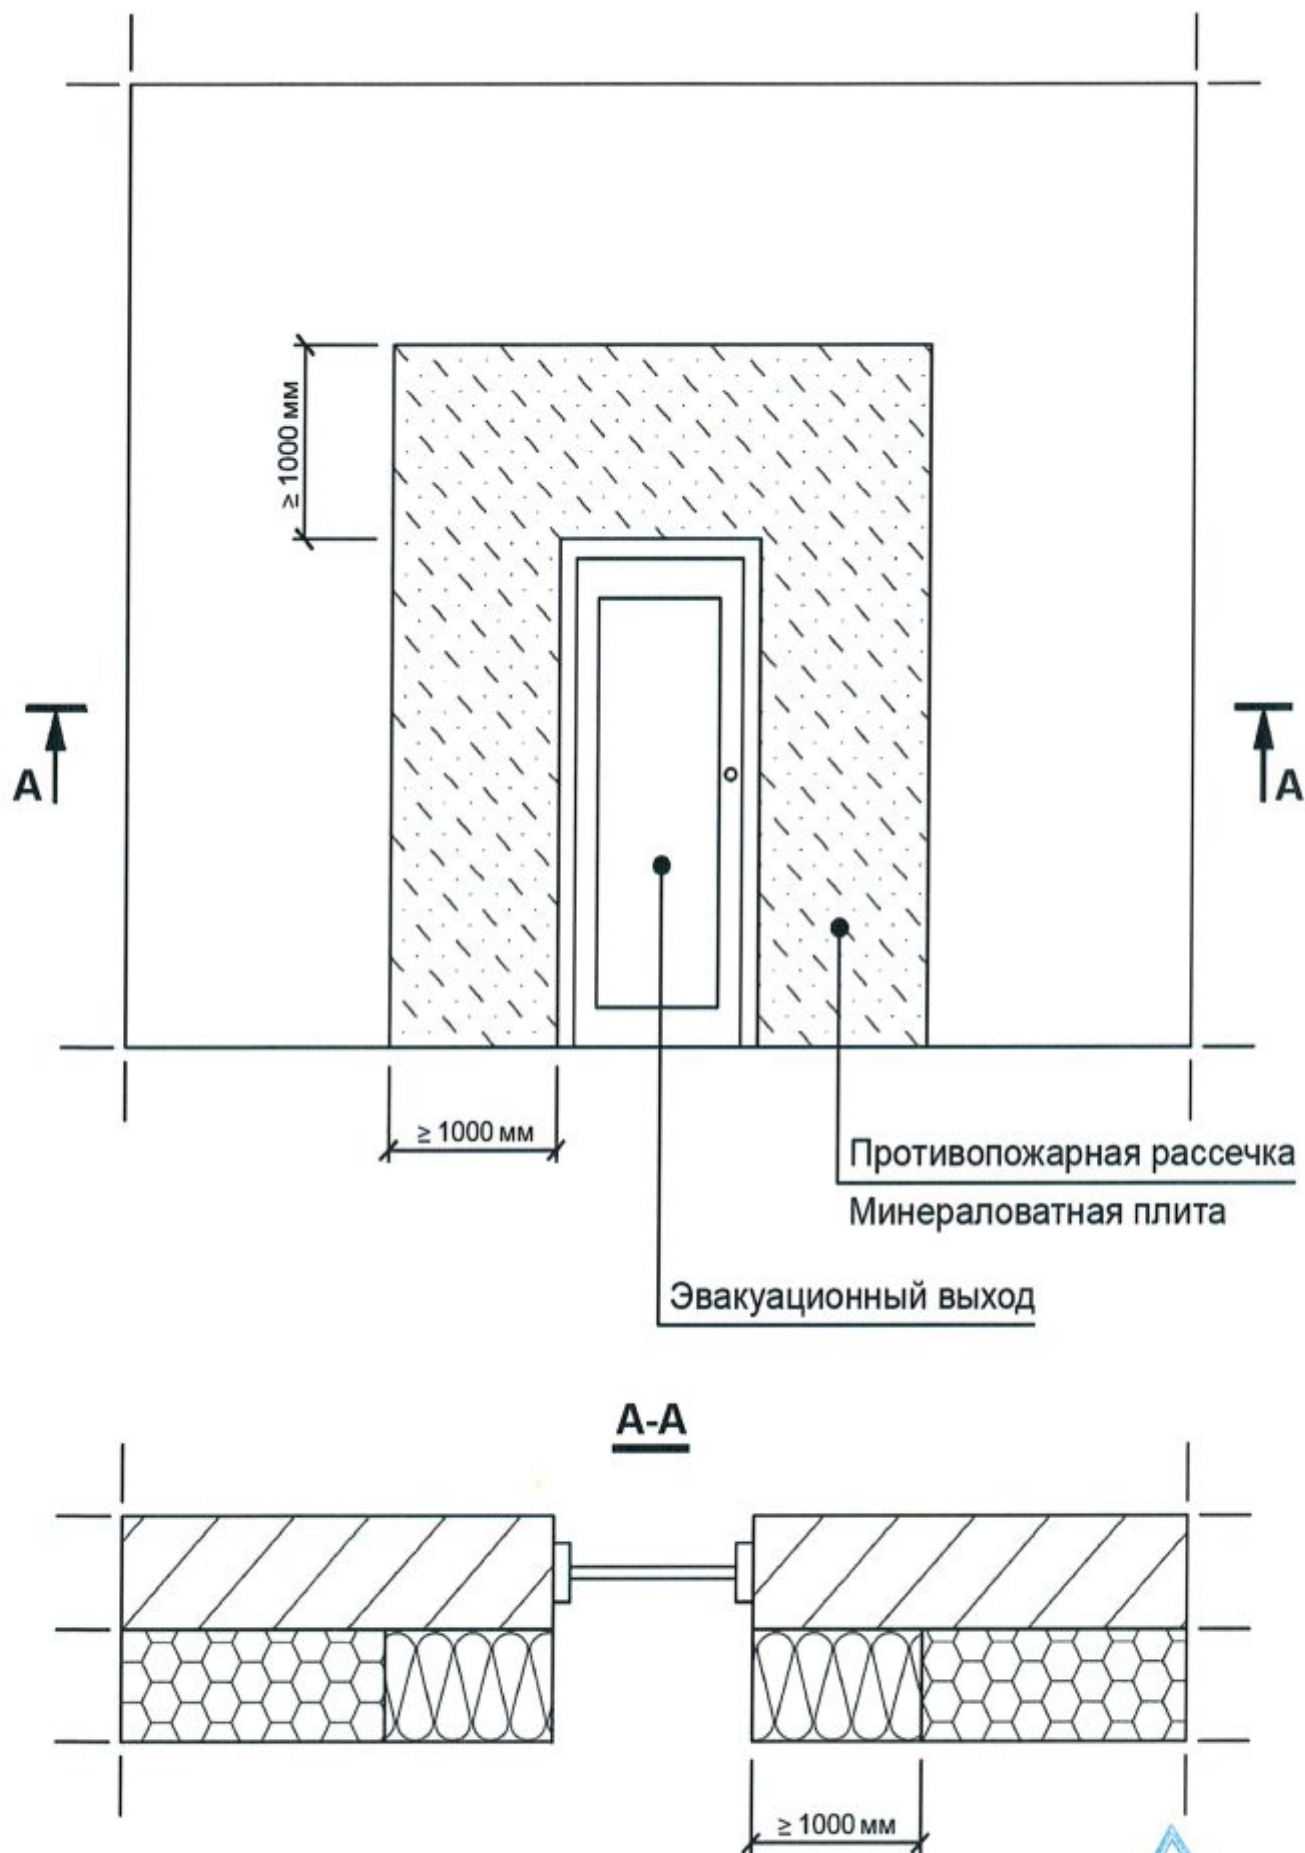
Участки наружных стен по периметру эвакуационных выходов из здания
